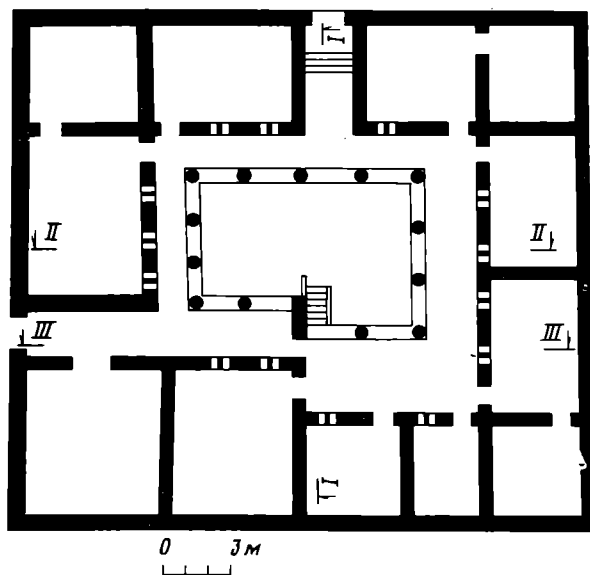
План дома IV—III вв. до н. э., реконструкция
